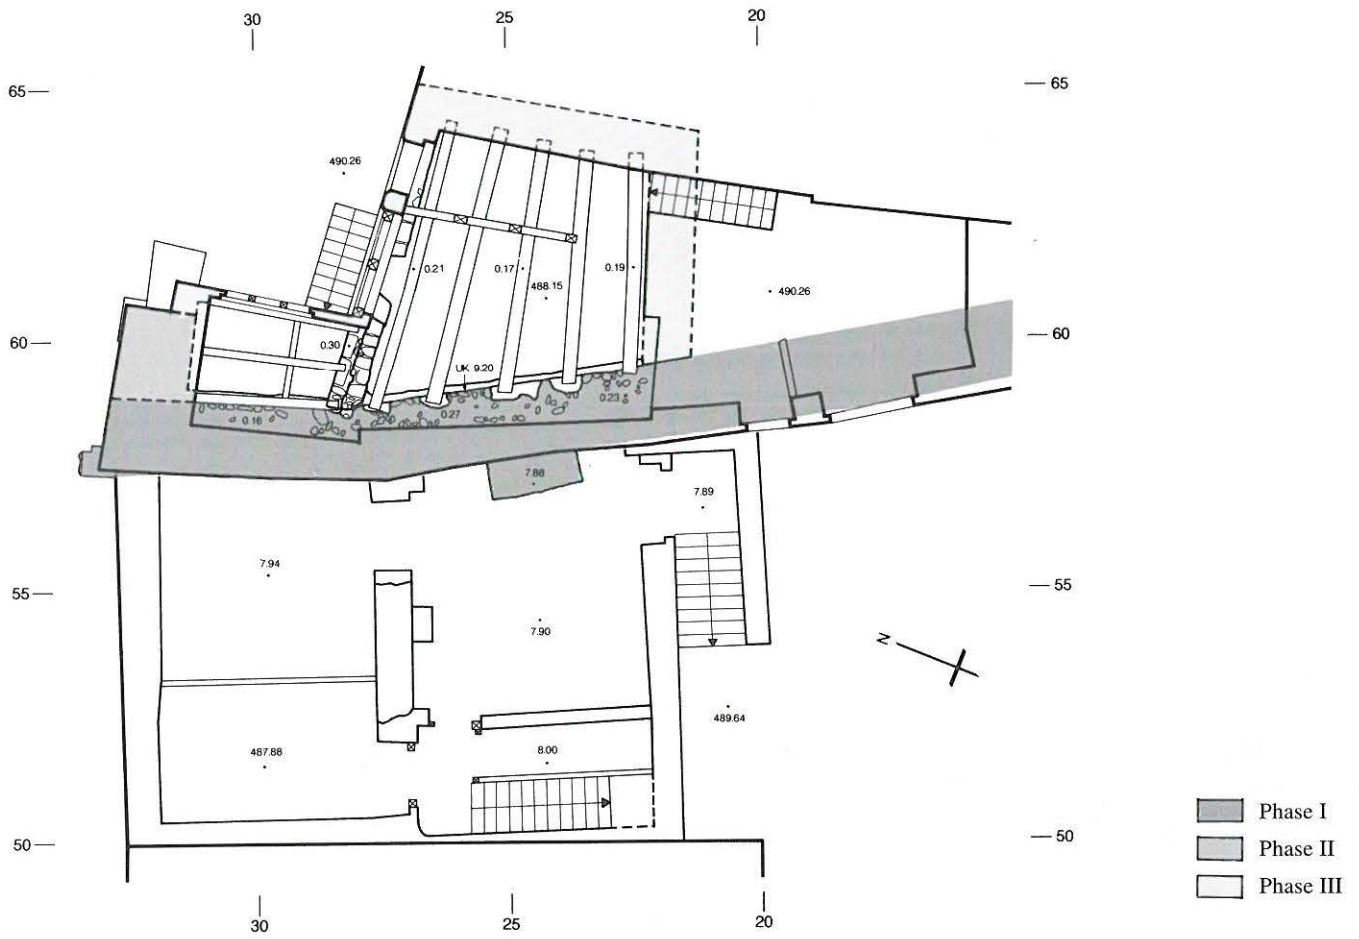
Laupen, Marktgasse 2/4. Grundriss mit Stadtmauerbefund, Murtentoranschluss und mutmasslichem Torwächterhaus. M. 1:150.
